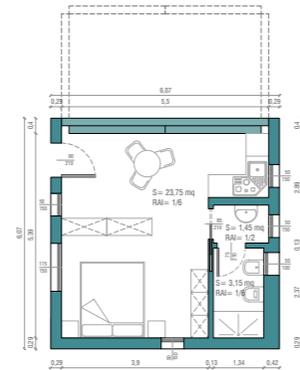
Pianta modulo singolo con pareti chiuse - variante 1. Scala 1:200
